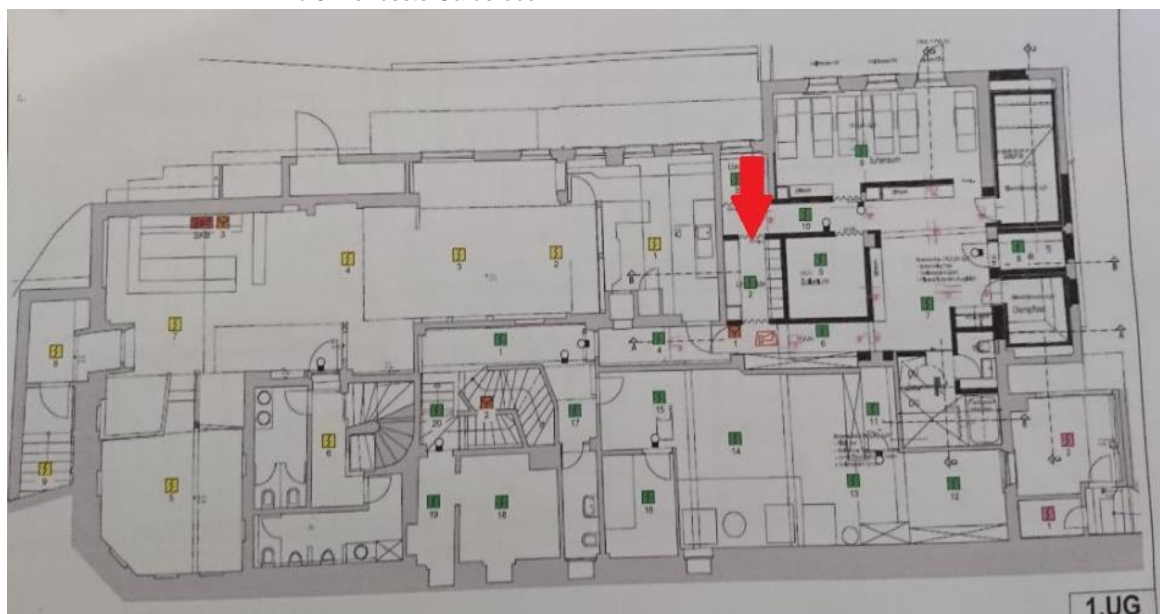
Blickrichtung Bild 11 auf dem Grundriss
